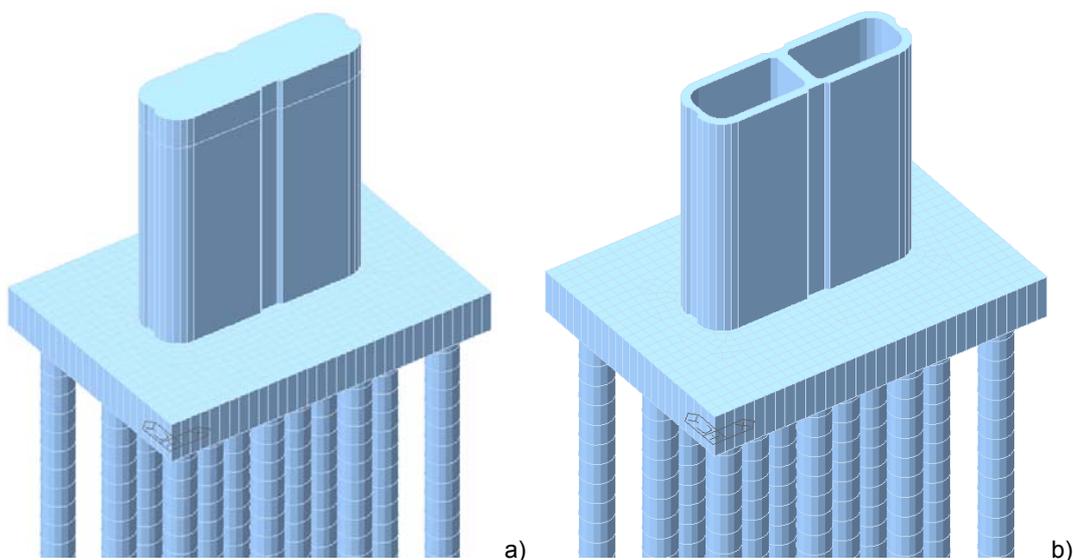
Modellazione tridimensionale agli Elementi Finiti – a) Vista 3D b) Spaccato
